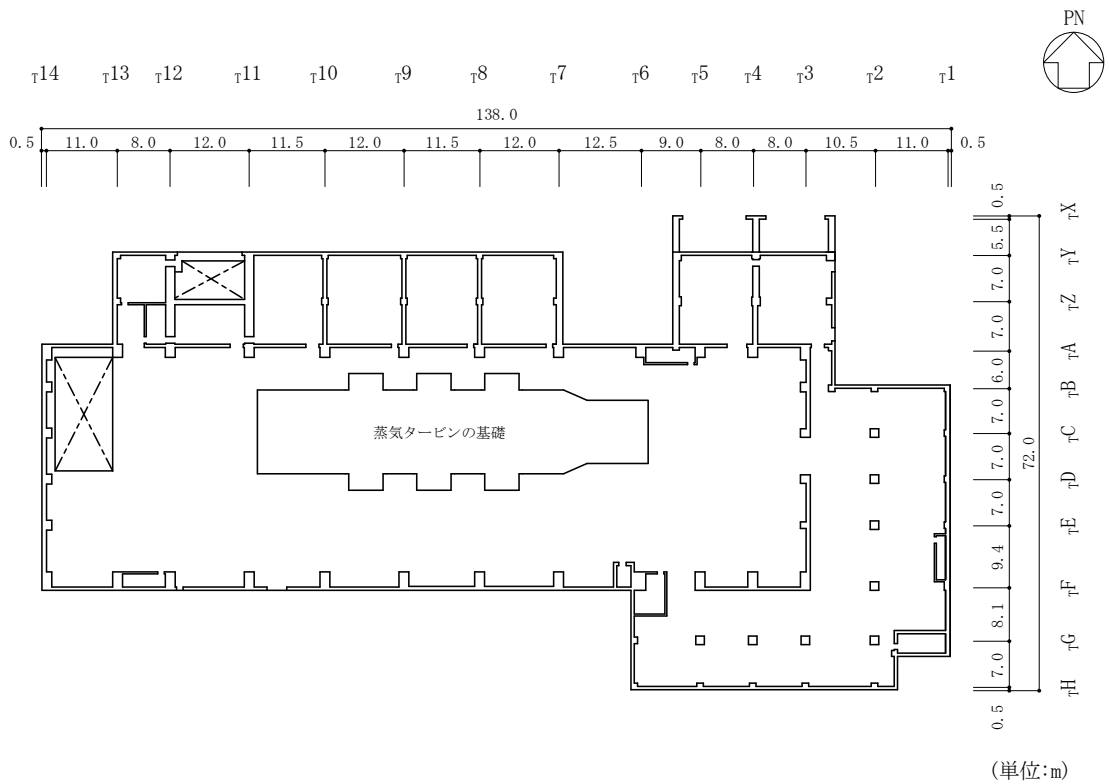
(4) タービン建物の概略平面図 (EL 20.6m)
